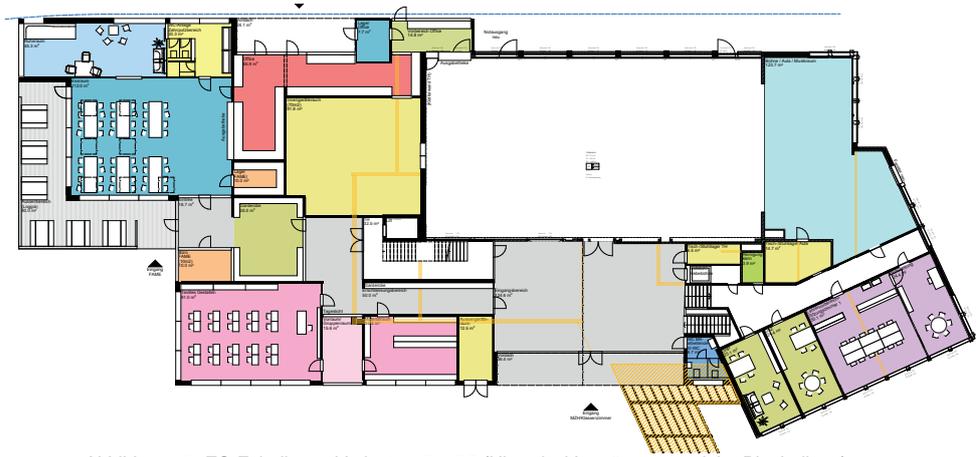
EG Feindispo - Variante 1 9.4.25 (Hinweis: Vergrößerung siehe Planbeilage)
